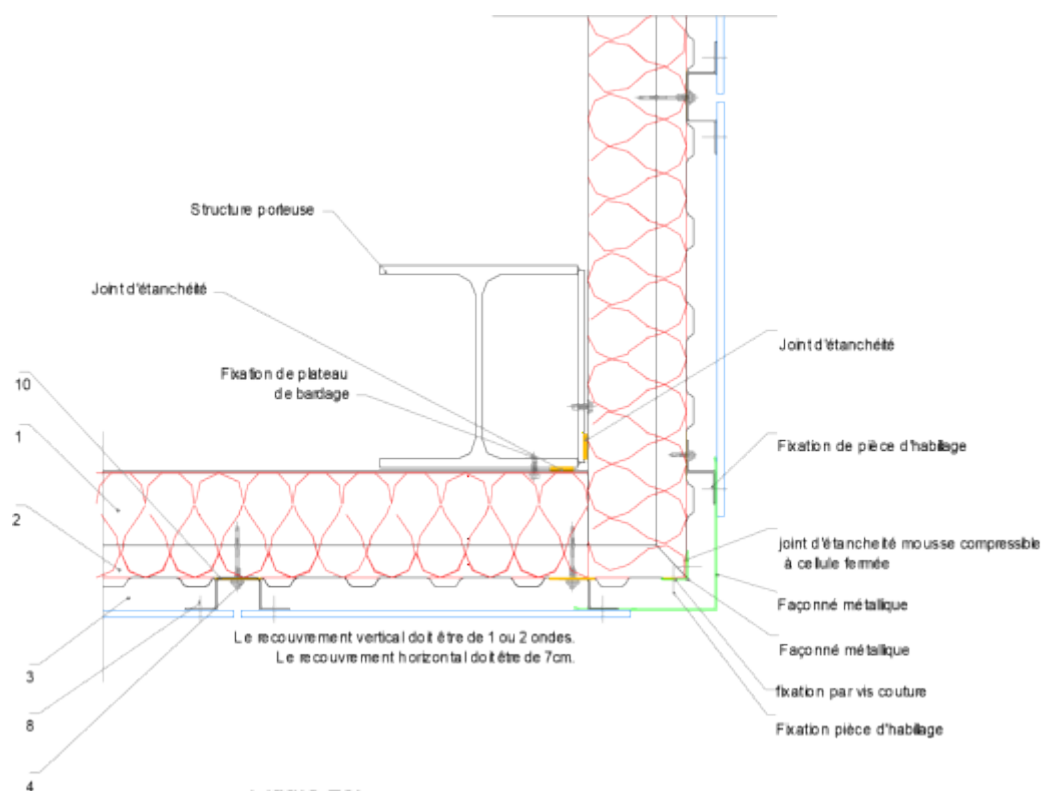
Angle sortant – Coupe horizontale avec PANNEAU EQUITONE
